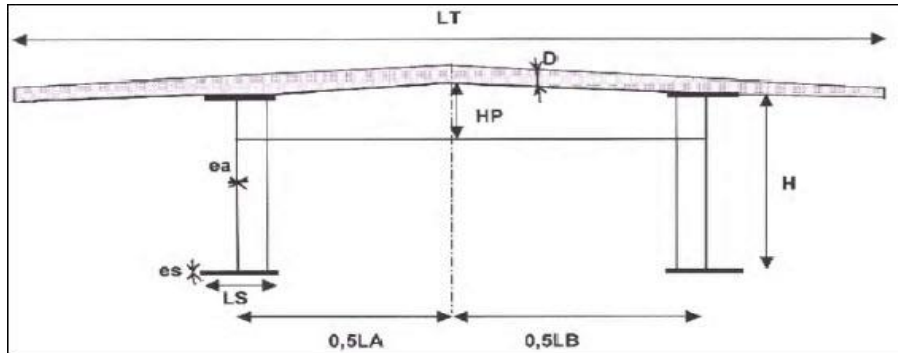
Coup transversale de bi-poutre avec pièce de pont sans console.
